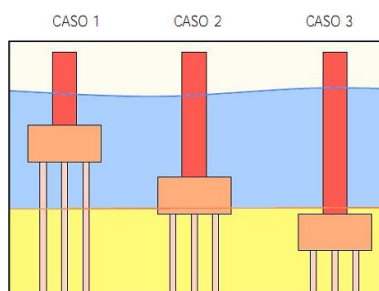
três situações para a previsão da profundidade de erosão em um pilar complexo.
